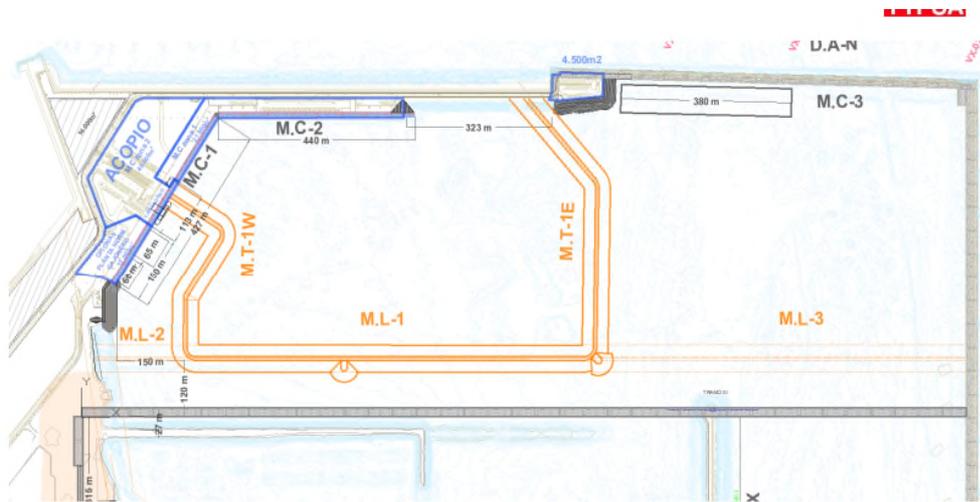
Vista en planta de las estructuras a desmontar. Fuente: Proyecto.
